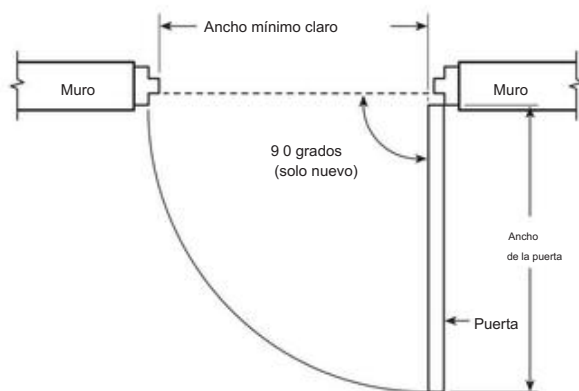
(a) Ancho libre mínimo.
